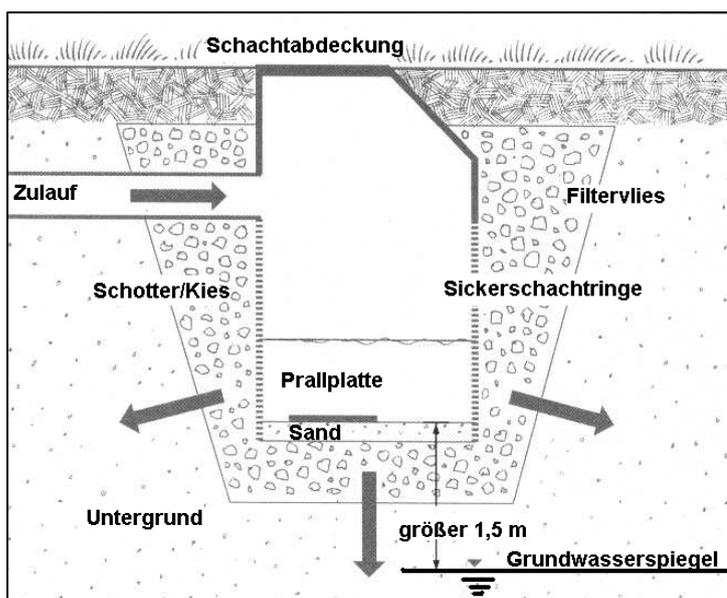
Schachtversickerung (Quelle: Praxisratgeber Entsiegeln und Versickern; modifiziert)
